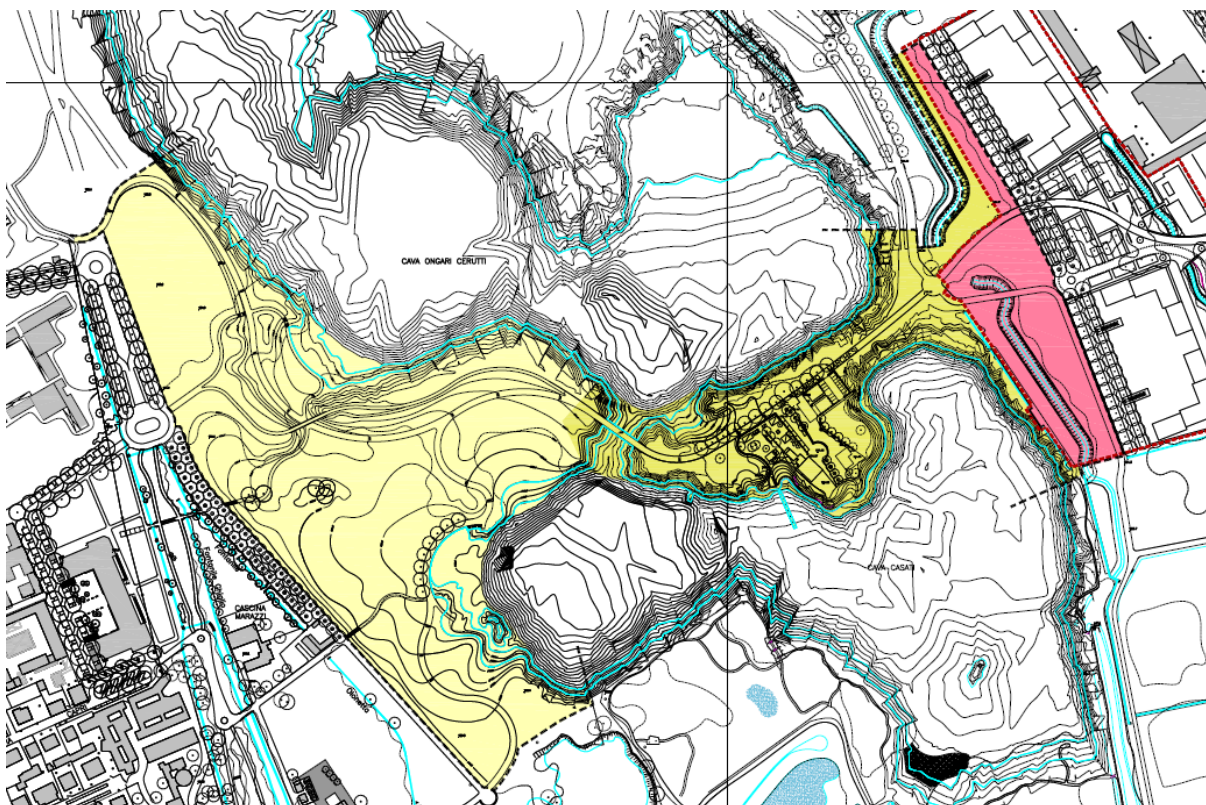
Sstralcio della tavola di progetto preliminare proposto dal CFU per le aree centrali: area di cessione al Parco delle Cave - PII Marchesi (rosa); lotto 1 La Bersagliera (giallo); lotto 2 valle dell'Olonetta (bianco panna).
